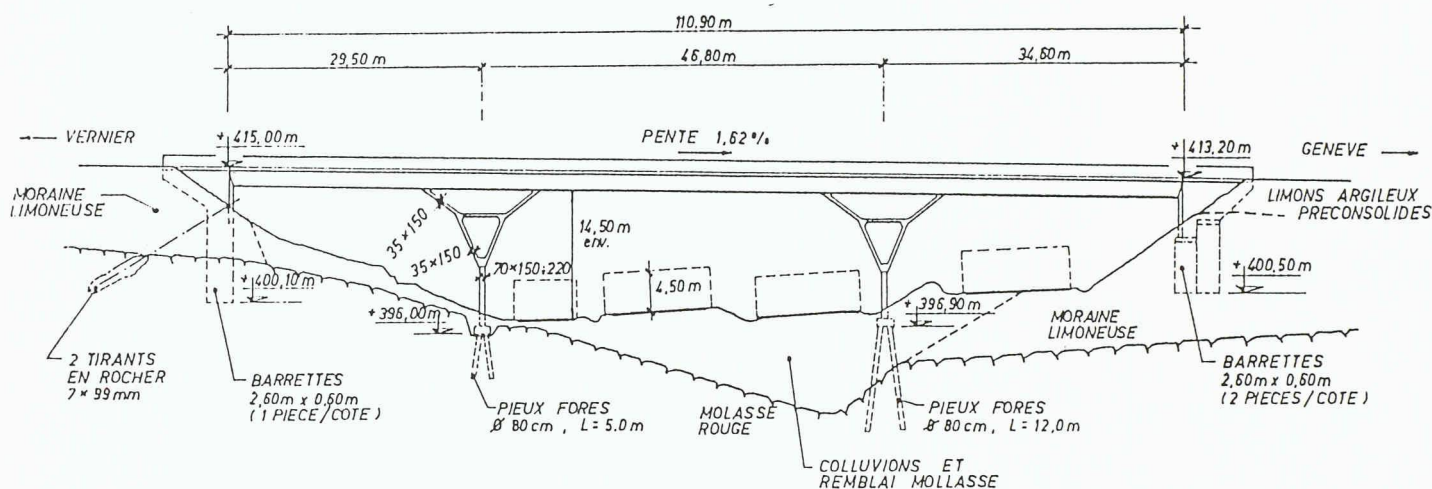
Passerelle du Bois-de-la-Grille pour deux-roues (OA 608)
